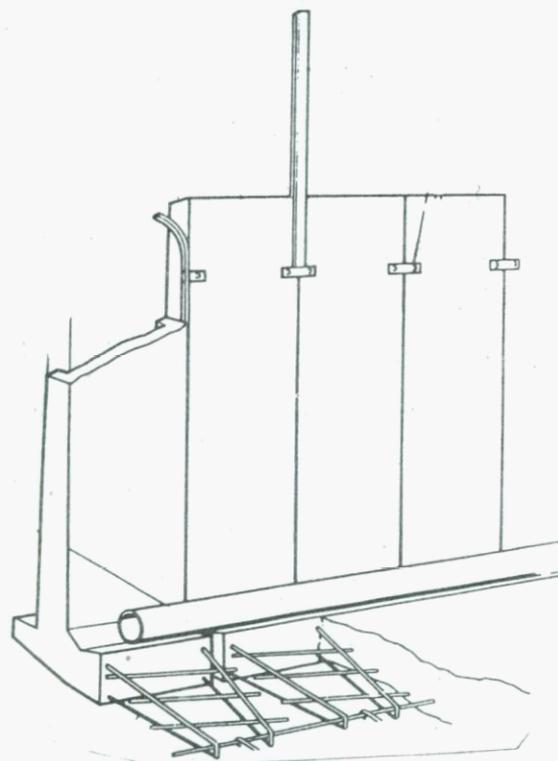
Muros completamente prefabricados. (MUROL-ST)
